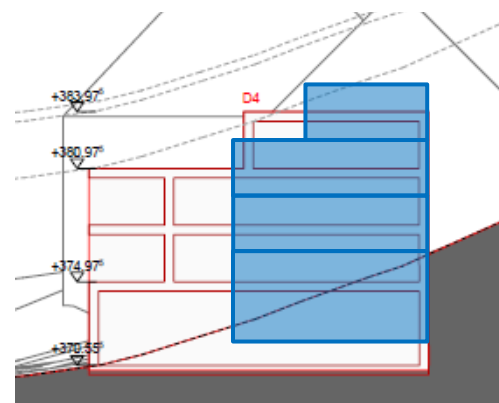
Ausschnitt Situationsplan - Baubereichsgruppe D und Skizze
